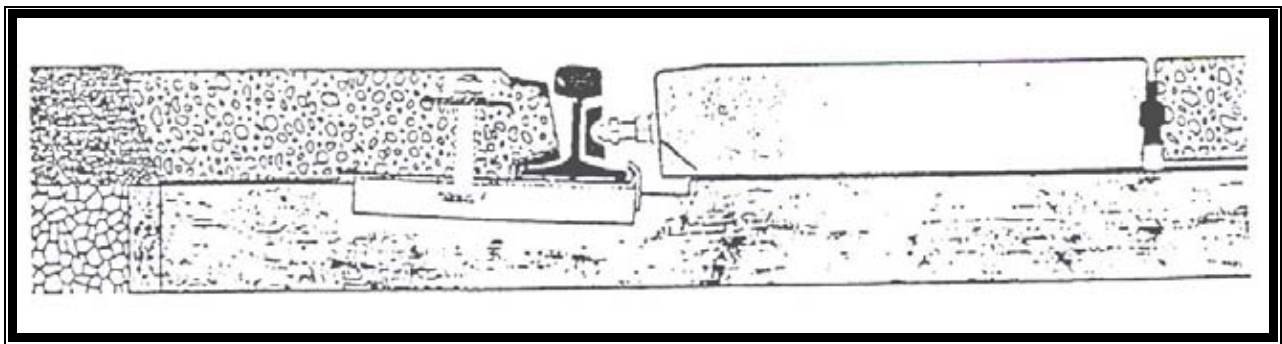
Vía con Durmientes de Hormigón
